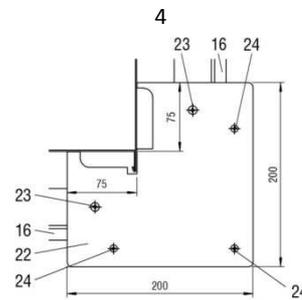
Metallständerwerk mit erforderlichen Auswechslungen für BKA-Ü mit Einbaurahmen ER (Wanddicke > 100 mm)
